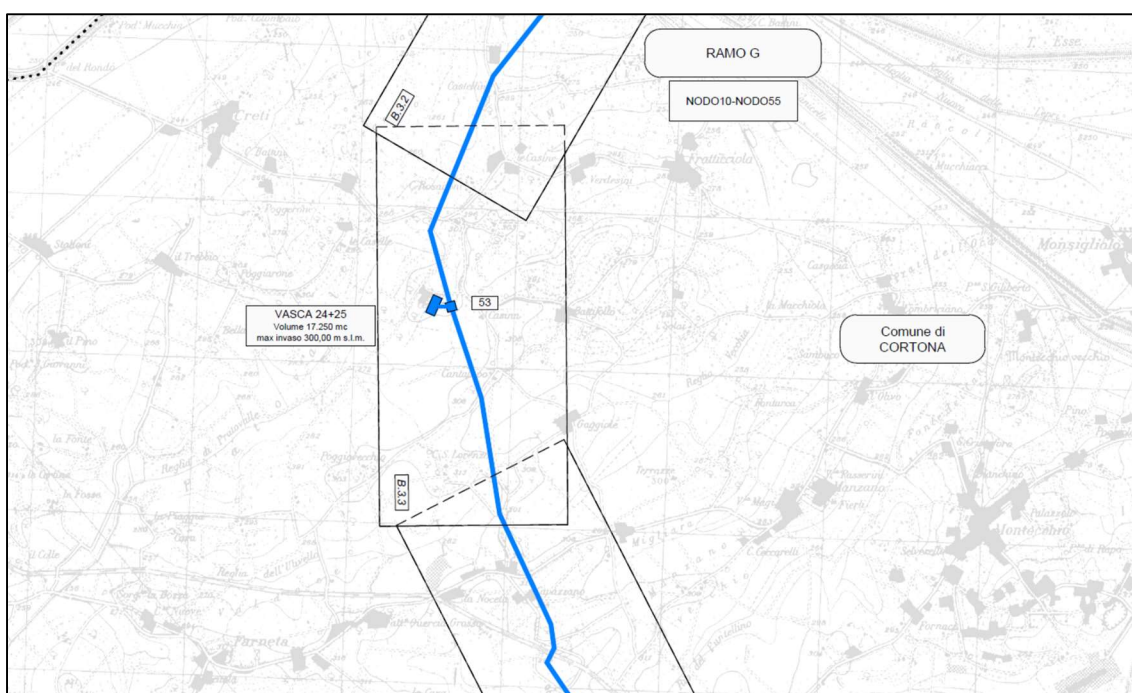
Stralcio planimetria generale di intervento – fuori scala- (Tav. B.2).
